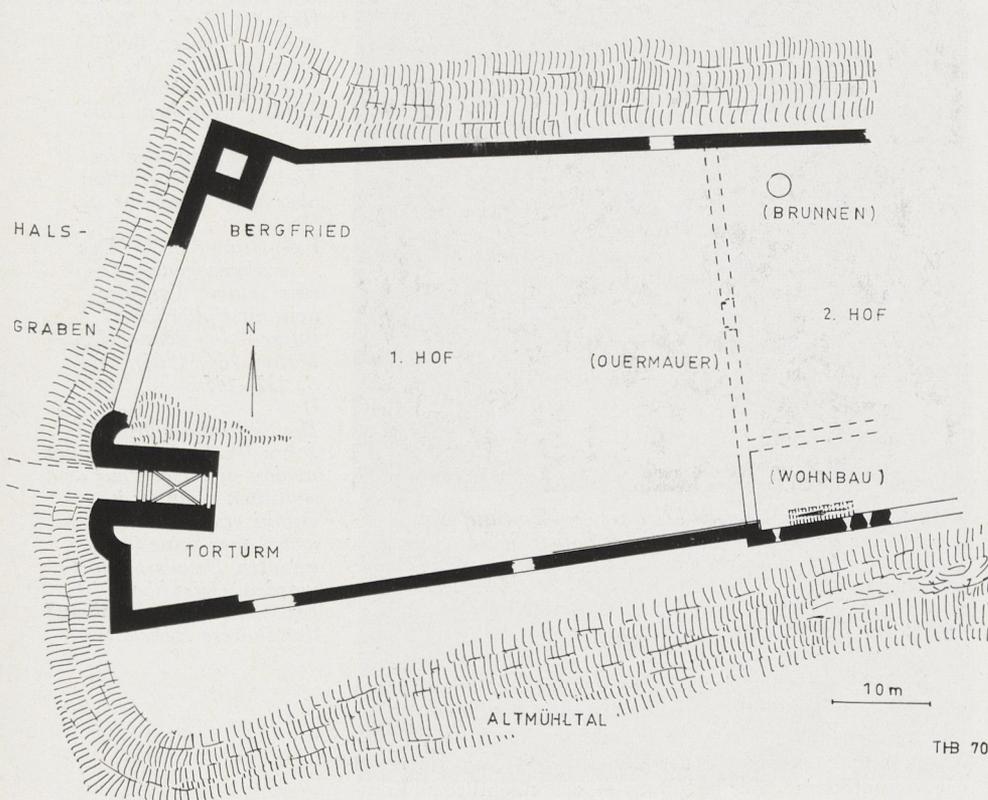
Burg Hirschberg. Grundrißskizze des westl. Burgteiles: Türme und Schildmauer an der Angriffsfront, Wohnbau mit der vermuteten Quermauer. Rekonstruktion nach dem heutigen Bestand (unter Benutzung der Grundrisse im Inventar, Zeichnungen Abb. 2 u. 3 vom Verfasser)
